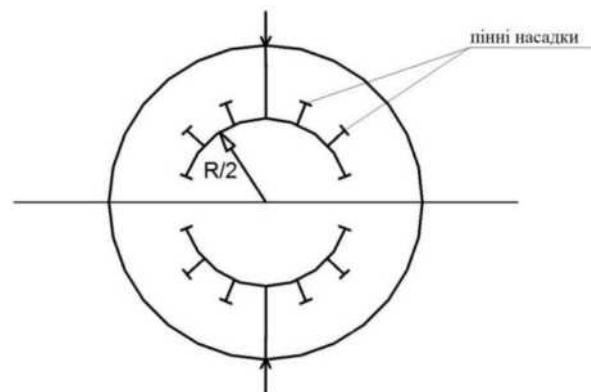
Принципова схема розташування пінних насадок всередині резервуара
